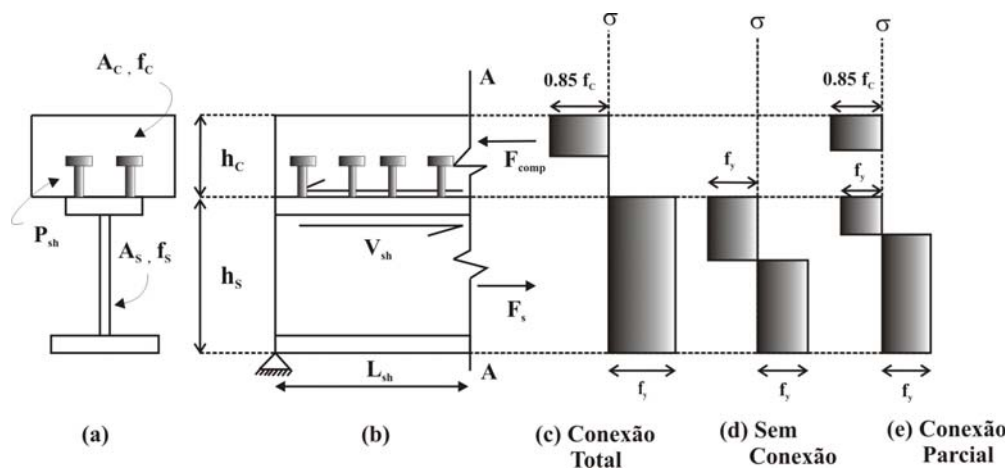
Equilíbrio longitudinal de forças na seção transversal de uma viga mista (OEHLERS *et al*, 1997).
